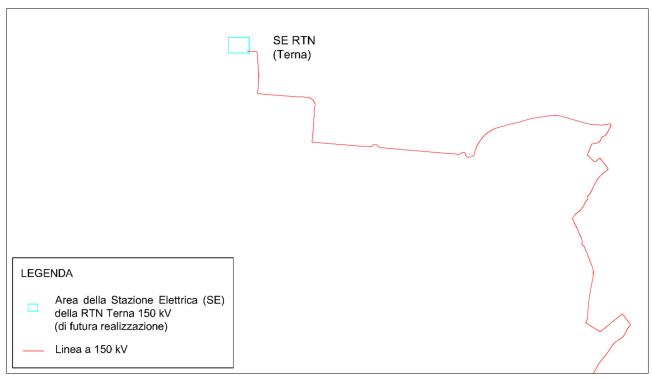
Dettaglio 3 planimetria generale di distribuzione linea a 150 kV
